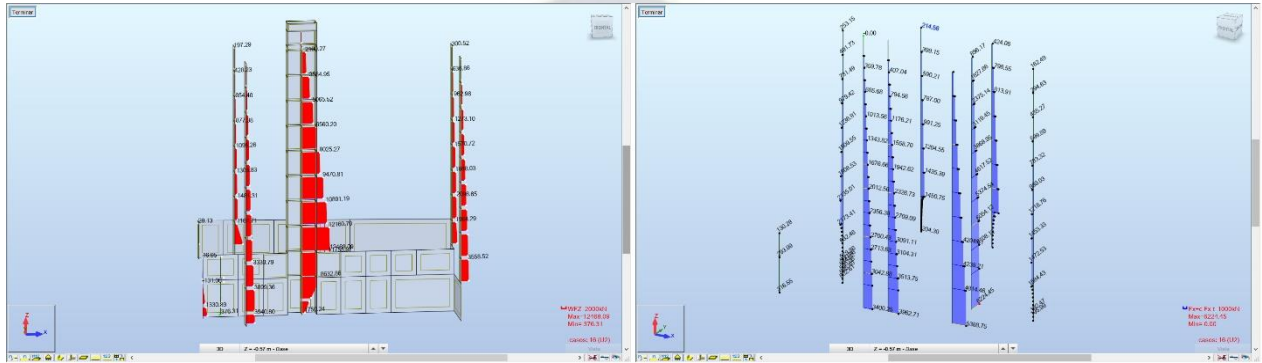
Fuerzas Normales en muros y columnas - Fuente: Elaboración Propia
